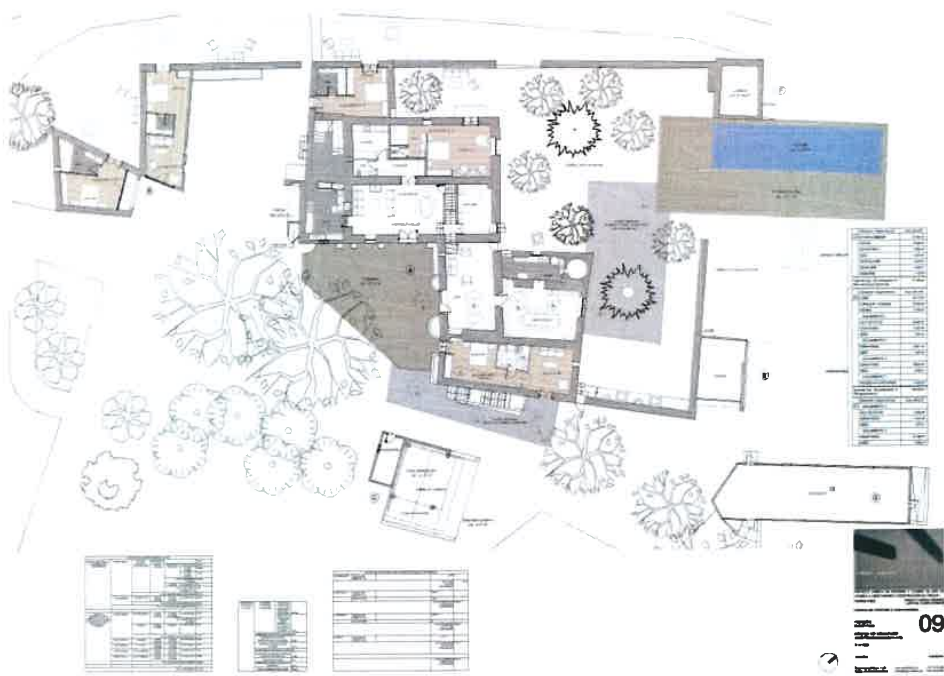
Agroturismo proyectado planta baja. Fuente: Juan Alba.
